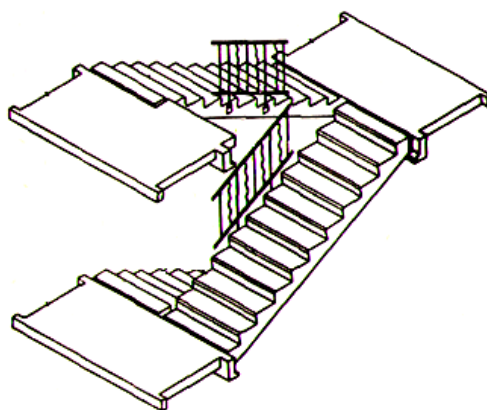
Деталь сходів з великорозмірних елементів: 1 – фризова ступень верхня; 2 – стійка огороження; 3 – сходинкова площадка
